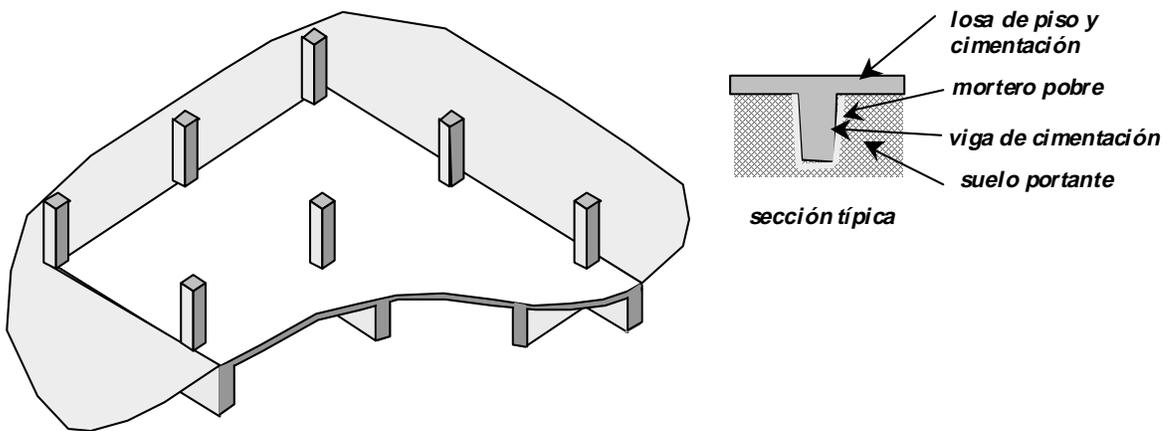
Losa de cimentación con vigas bajo ella.
